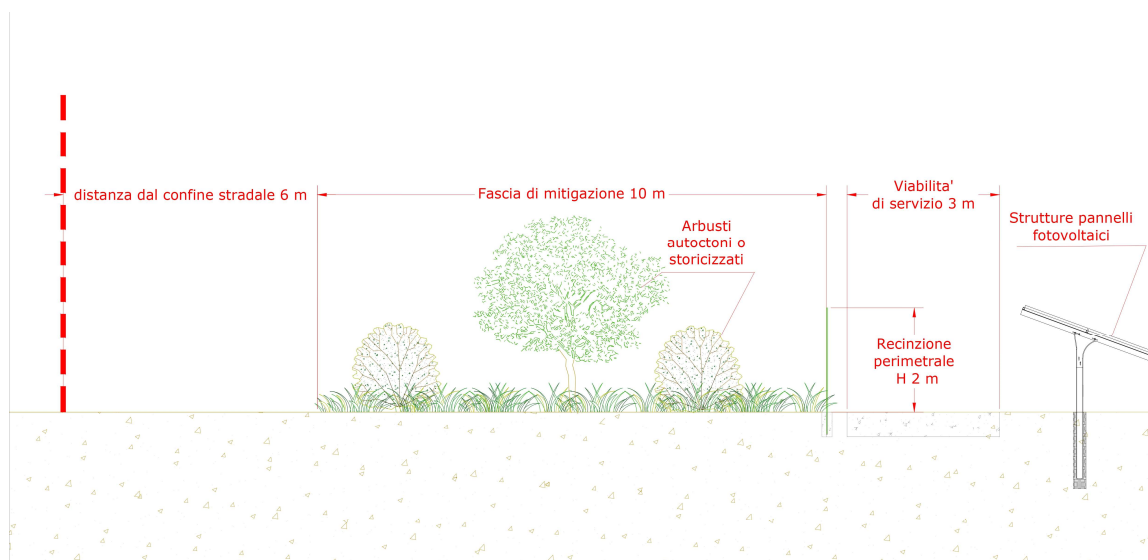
Particolare fascia di mitigazione lungo il perimetro dell'impianto – particolare lato nord
